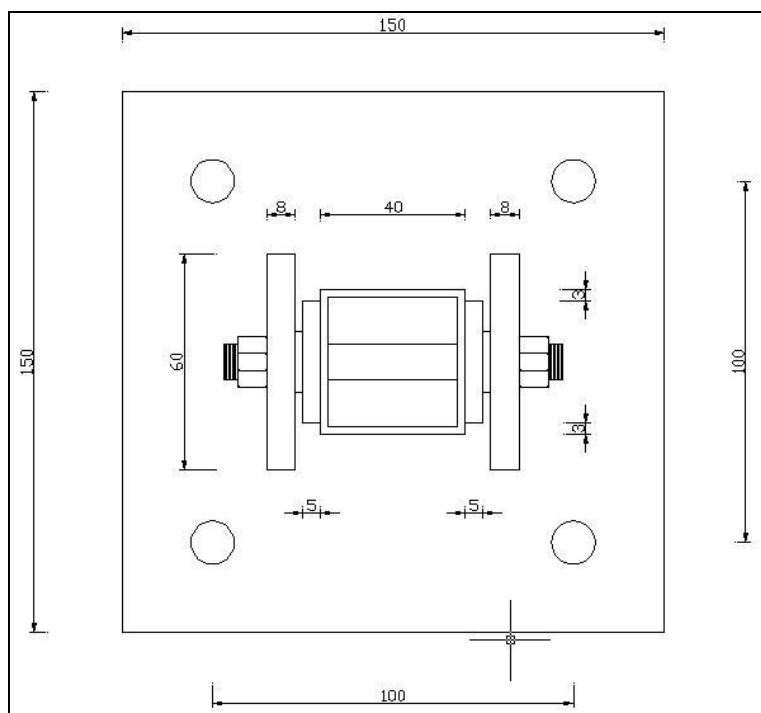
Detalle del Apoyo. Vista en Planta.
